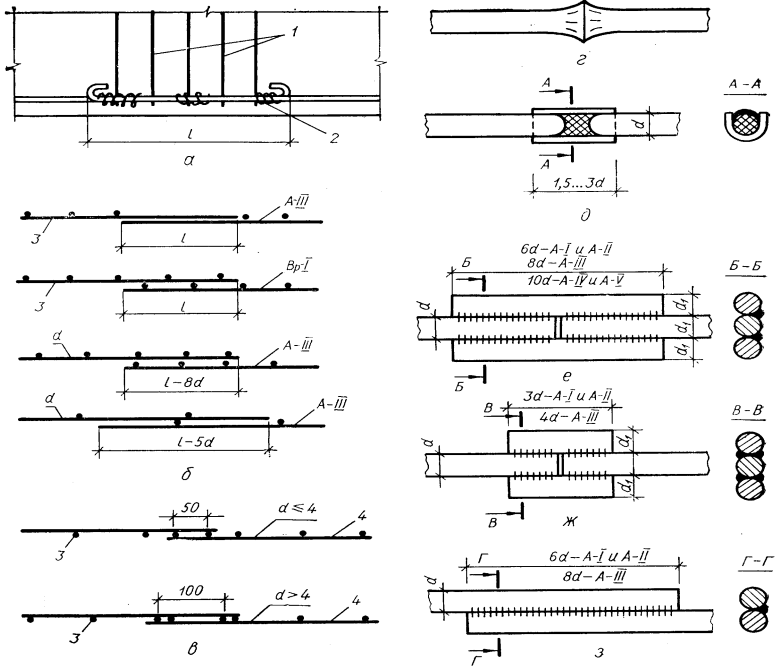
Стикування стержнів та сіток унапусток і стержнів зварюванням: *а* — стержнів; *б* — сіток у напрямі робочої арматури; *в* — те саме, у напрямі розподільної арматури; *г* — стикування стержнів зварюванням устик; *д* — ванним зварюванням; *е* — з накладками при односторонніх швах; *ж* — те саме, при двосторонніх швах; *з* — унапусток при односторонніх швах; 1 — додаткові хомути площею не менш ніж половина площі арматури, що стикується; 2 — в'язальний дріт; 3 — робоча арматура; 4 — розподільна арматура
